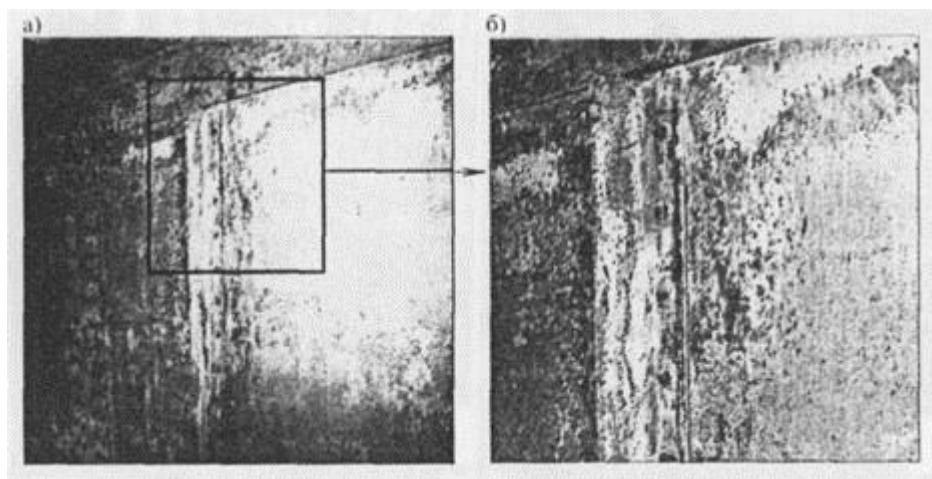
Отслаивание покрытия, выполненного тонким слоем по пыльной поверхности. Отслаивание тонкой пленки происходит без шелушения
